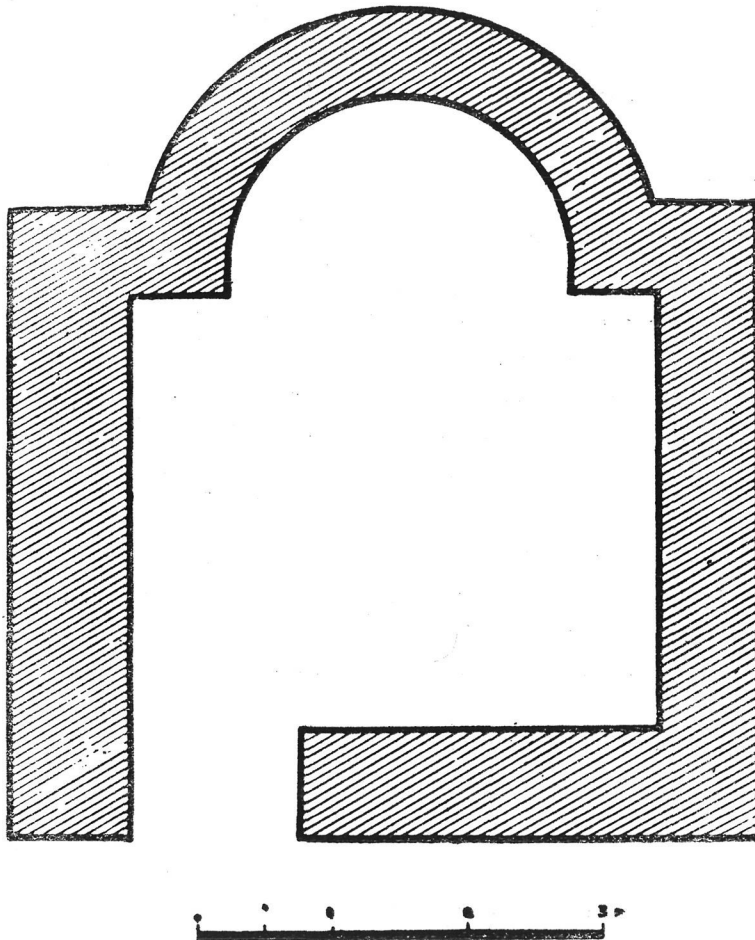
Planta del edificio próximo a la basílica, posible baptisterio.
